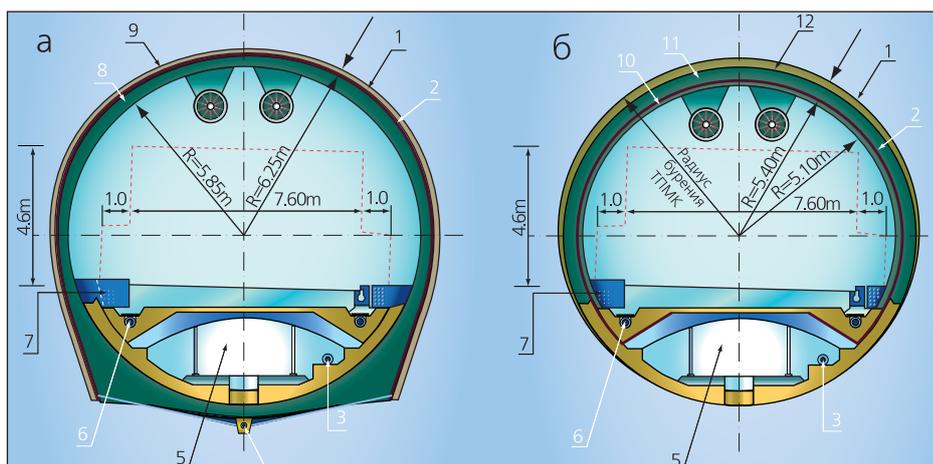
Поперечные сечения автодорожного тоннеля PINGLIN: а – на участках, пройденных горным способом; б – с помощью ТПМК: 1 – контур выработки; 2 – мембранная гидроизоляция; 3 – пожарный водовод; 4 – глухая дренажная труба; 5 – Сервисная галерея; 6 – дренаж; 7 – группа каналов; 8 – бетонная обделка; 9 – горная крепь; 10 – обделка из монолитного бетона; 11 – сборная железобетонная обделка; 12 – нагнетание за обделку
